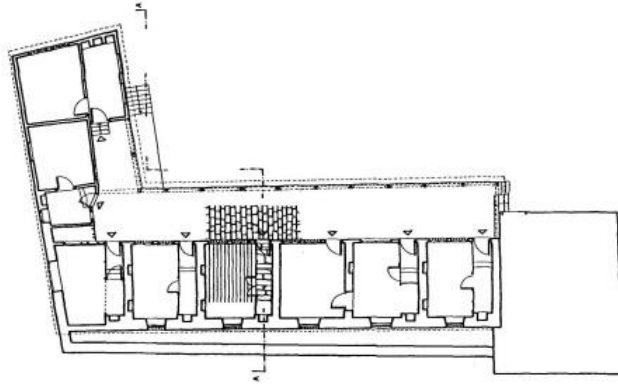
مسقط أفقي لمدرسة محمد علي باشا بمجمعه المعماري في كافالا (الطابق العلوي، مقياس رسم 1:350)
